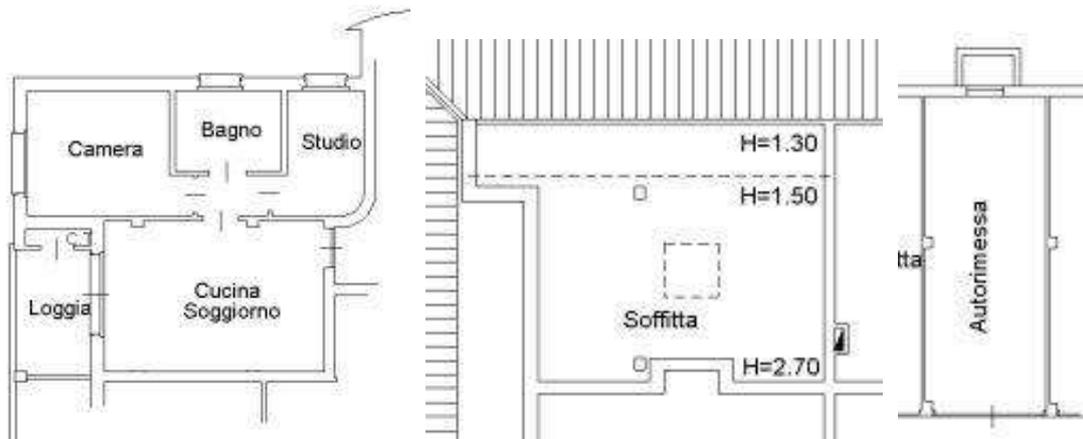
Estratto planimetria catastale appartamento e autorimessa.
